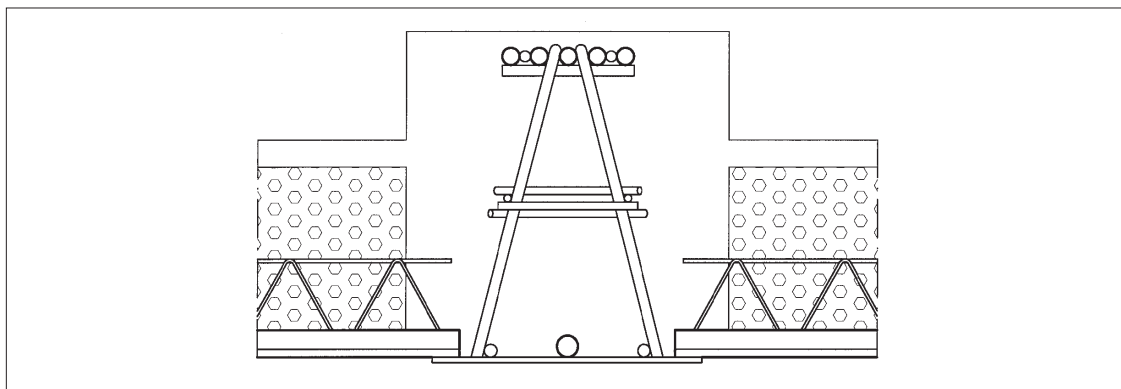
Trave fuori spessore a rialzo con fondello in acciaio a ribasso.
